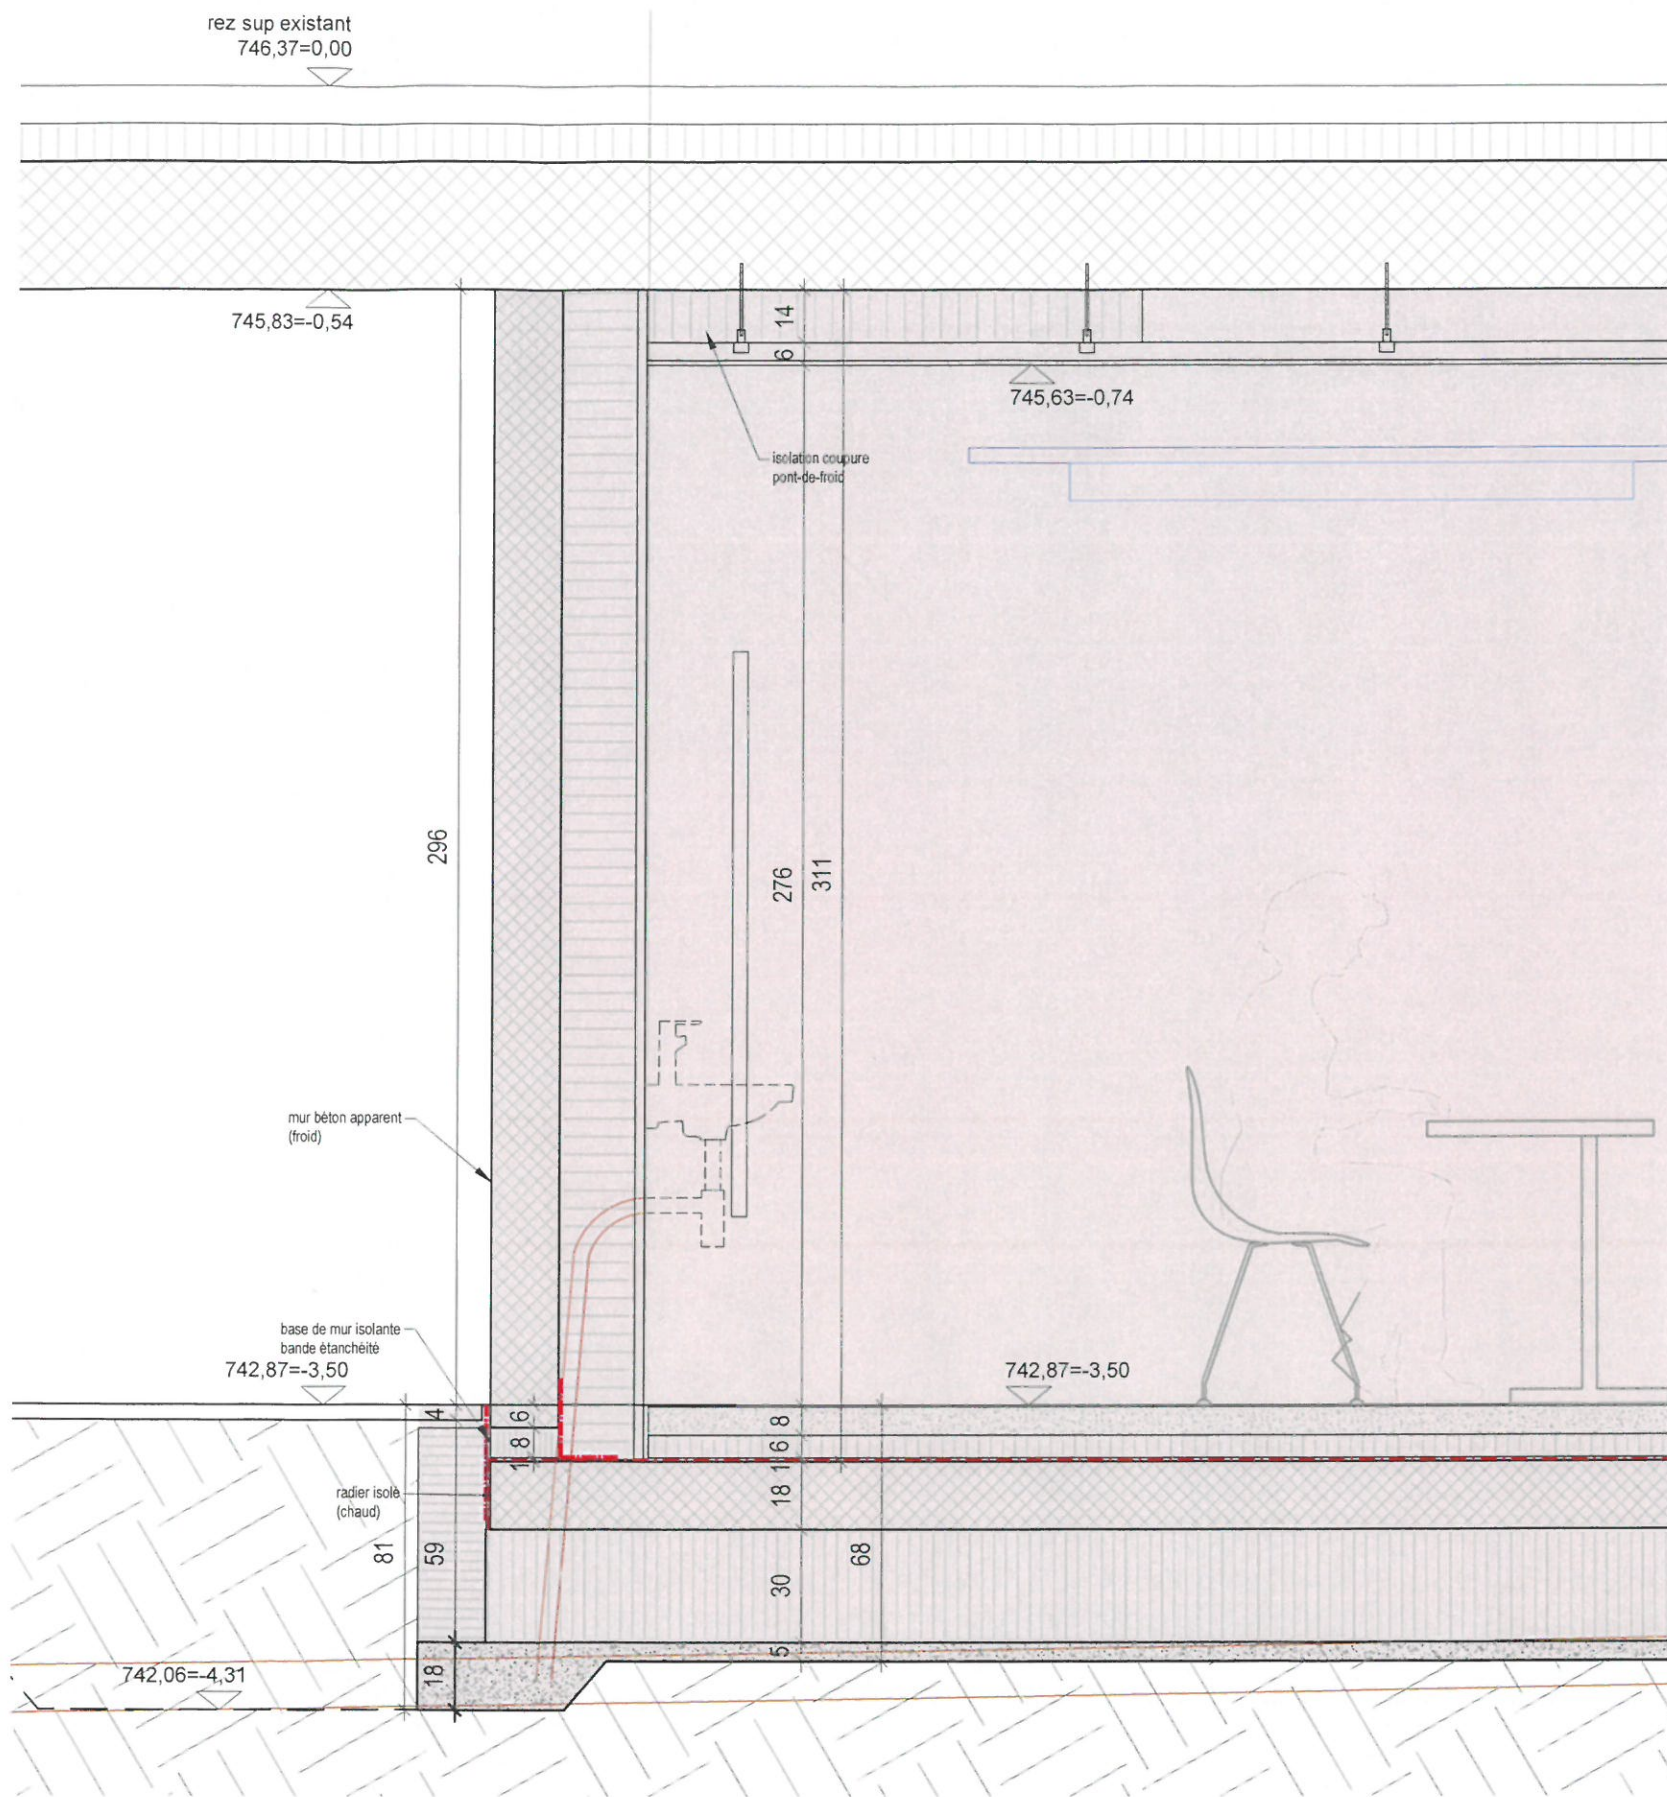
DETAILS COUPES BB & CC\_NOUVELLE SALLE DE CLASSE
